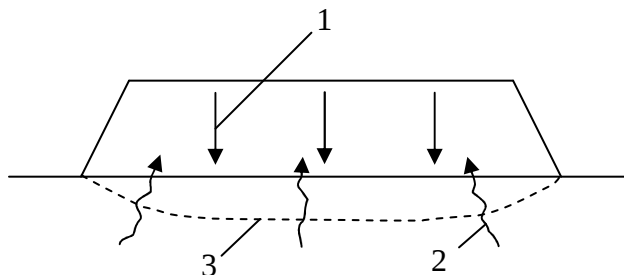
Ущільнення водонасиченого глинистого ґрунту привантаженням: 1 – тиск відсипки фільтруючим ґрунтом (пісок, щебінь); 2 – напрямок фільтрації ґрунтової води; 3 – лінія осідання поверхні ґрунту
